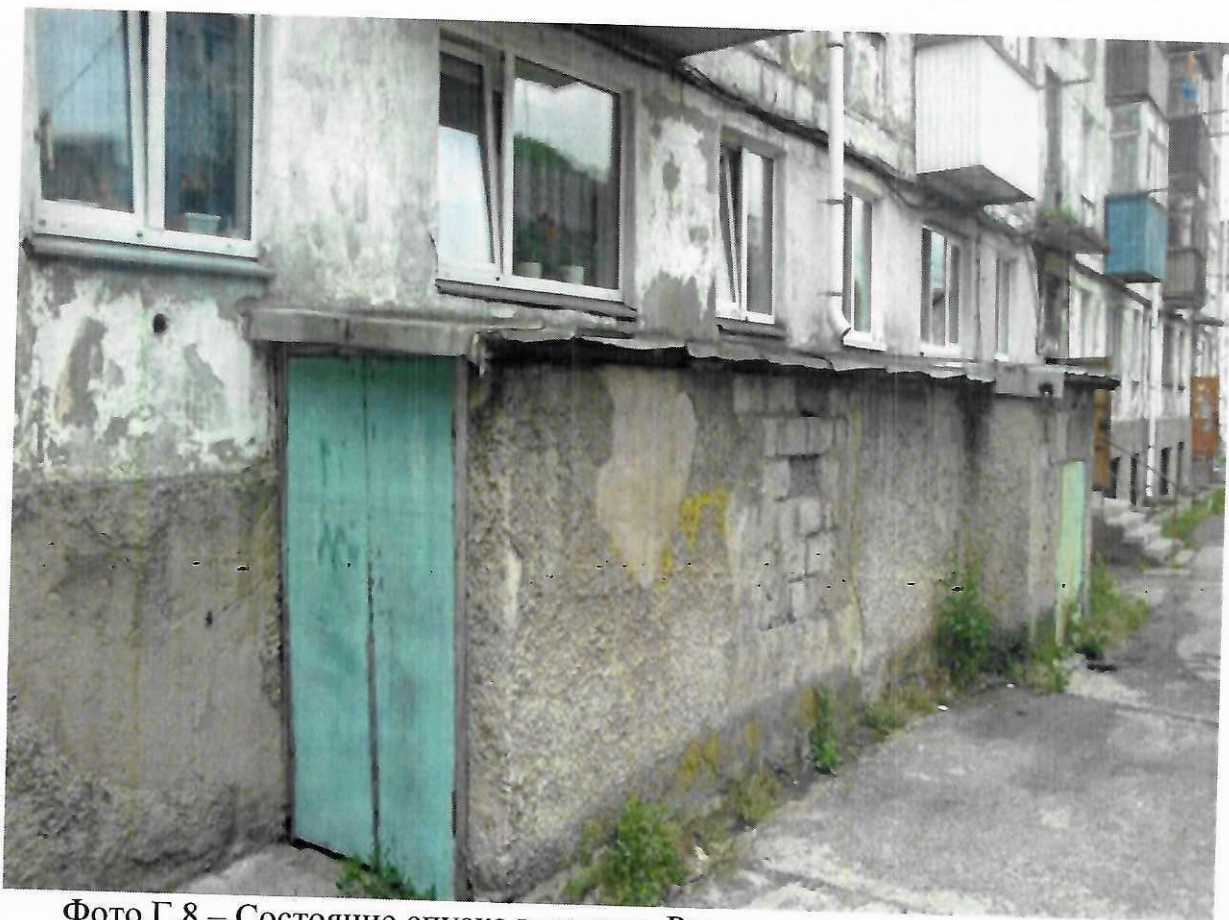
Состояние спуска в подвал. Разрушение кладки, отслоение штукатурного слоя стен. Покрытие фальц по деревянному каркасу.
